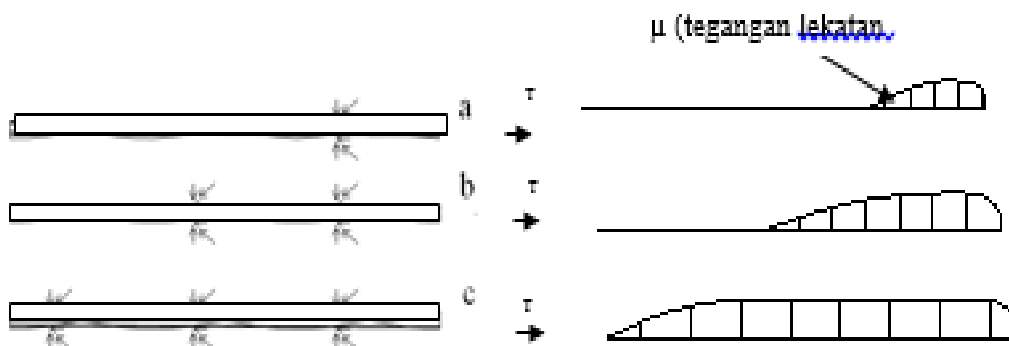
Panjang tulangan ( $ld$ ) yang tertanam dalam beton
